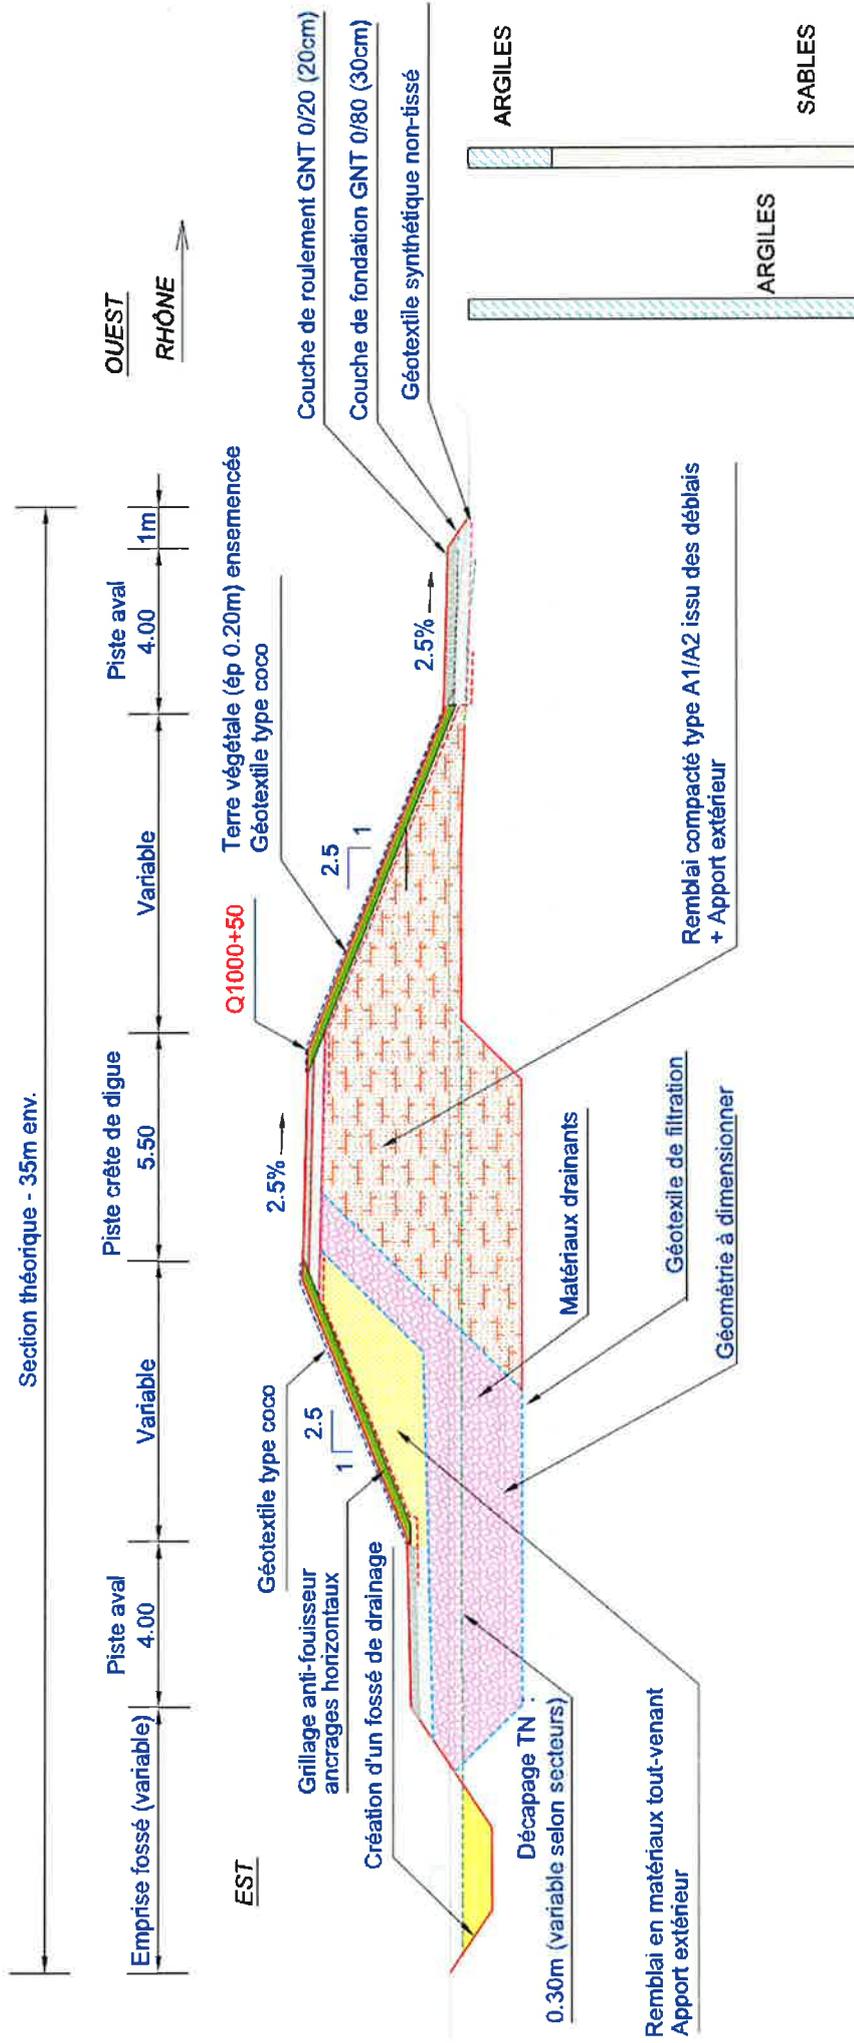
Coupe type de la digue : Remblai amont étanche avec filtre et drain sur la partie aval
